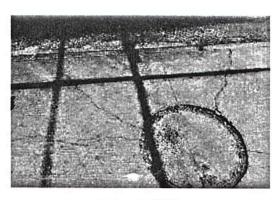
Lugar: Pasaje Padre Francisco Gun Bayer, frente N° 3.265, Puente Alto. Observación: Fisura.
